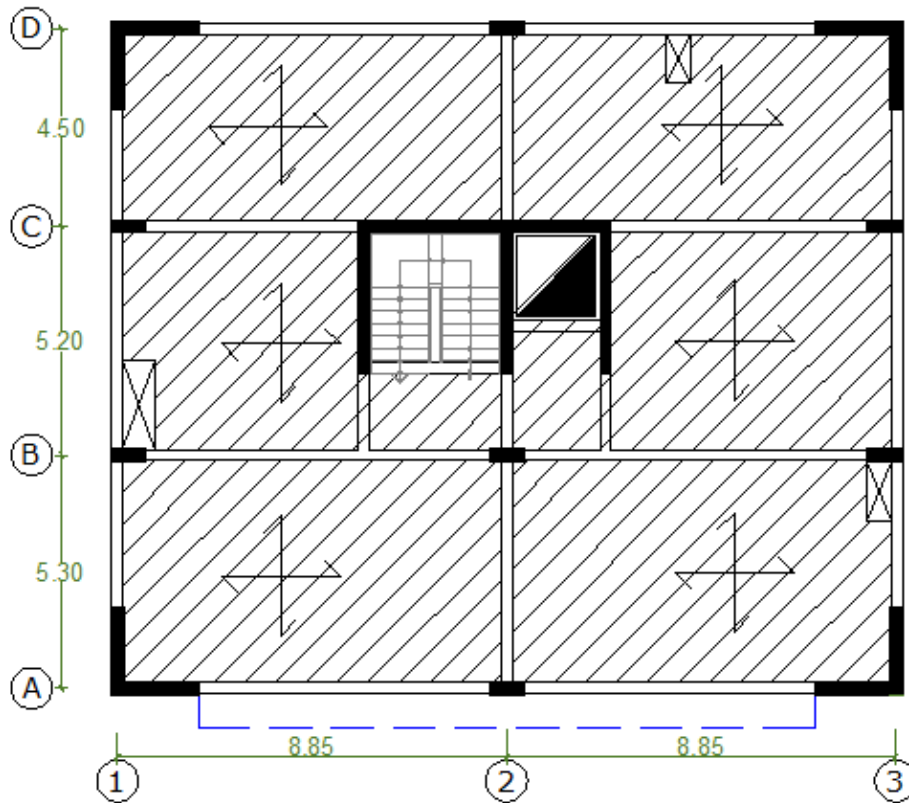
Dimensiones de la losa aligerada en elevación.
